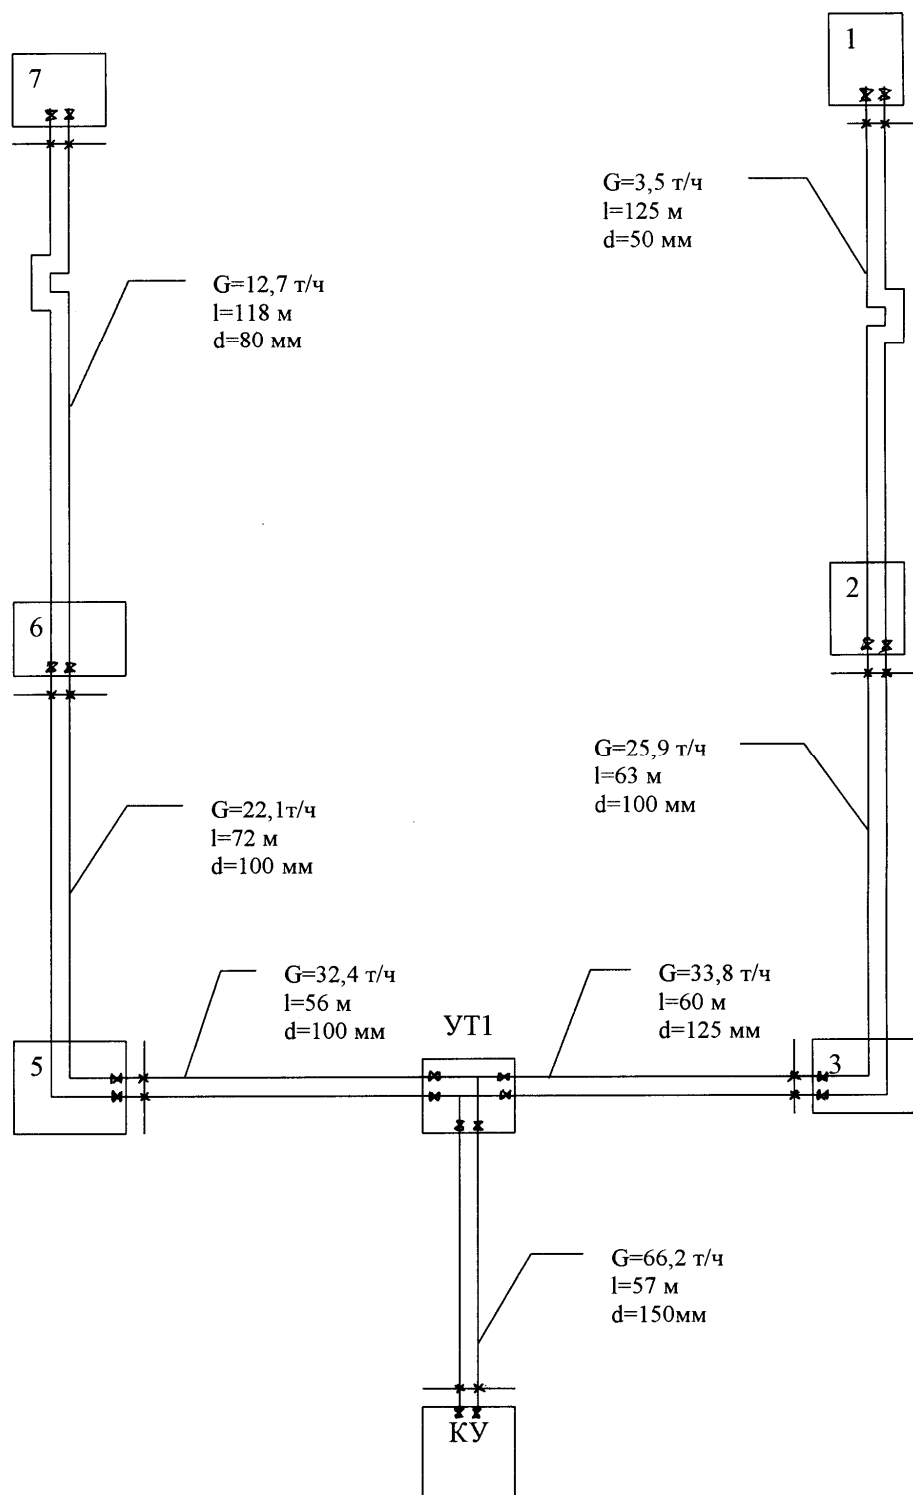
Расчетная схема тепловой сети до реконструкции
